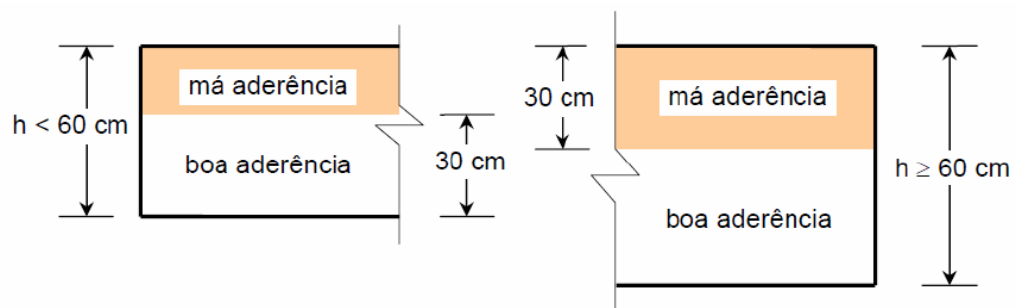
Situações de boa e má aderência para armaduras horizontais
